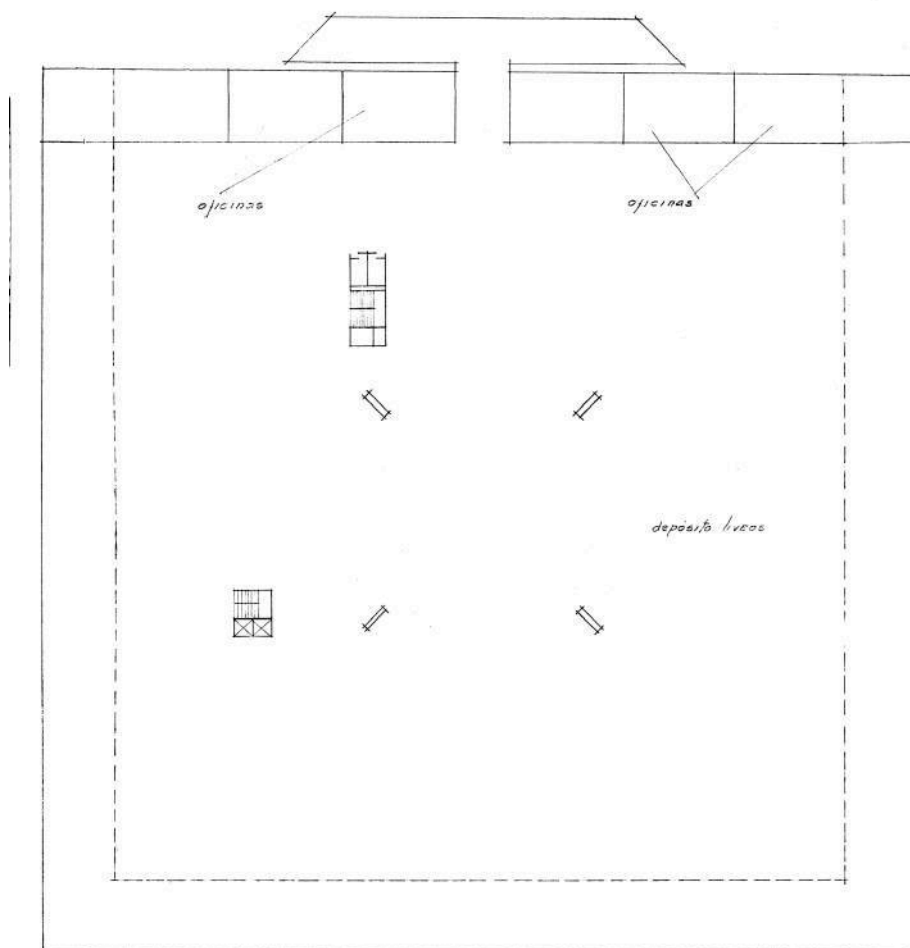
BNB, planta baixa – 1º subsolo, 1969. Fonte: ArqPDF.
